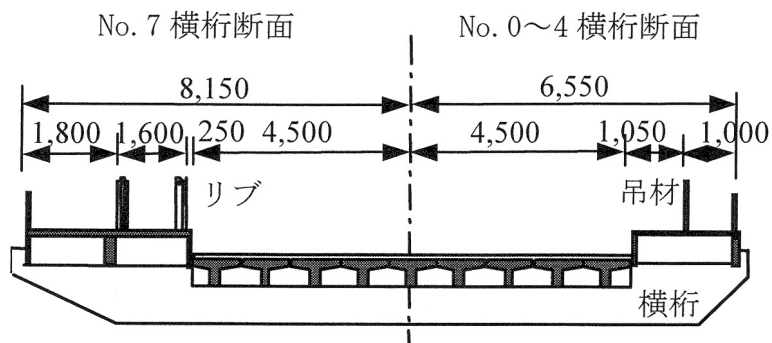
石潭溪大橋の床組断面図（寸法単位：mm）¹⁾
